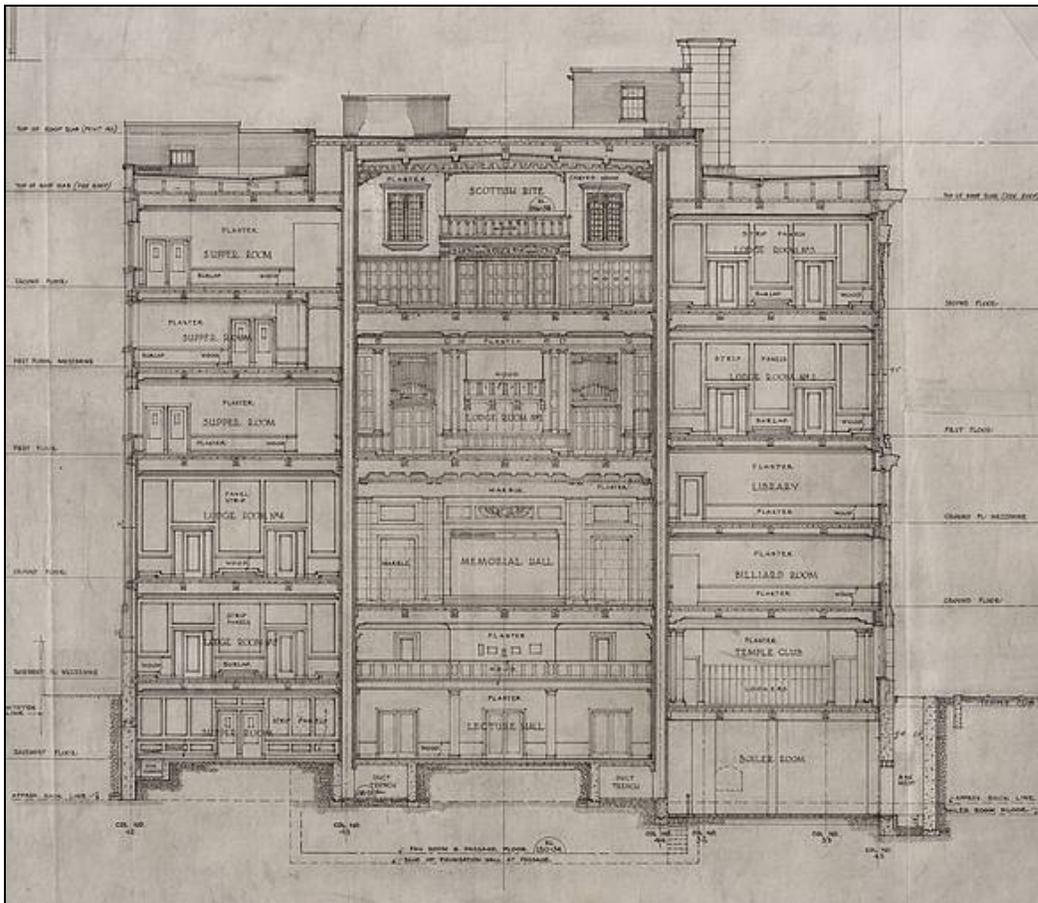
Coupe (détail de la feuille du dessin) montrant trois divisions verticales. La salle du bas possède un balcon. Plans de John S. Archibald, Université McGill, collection CAC.
